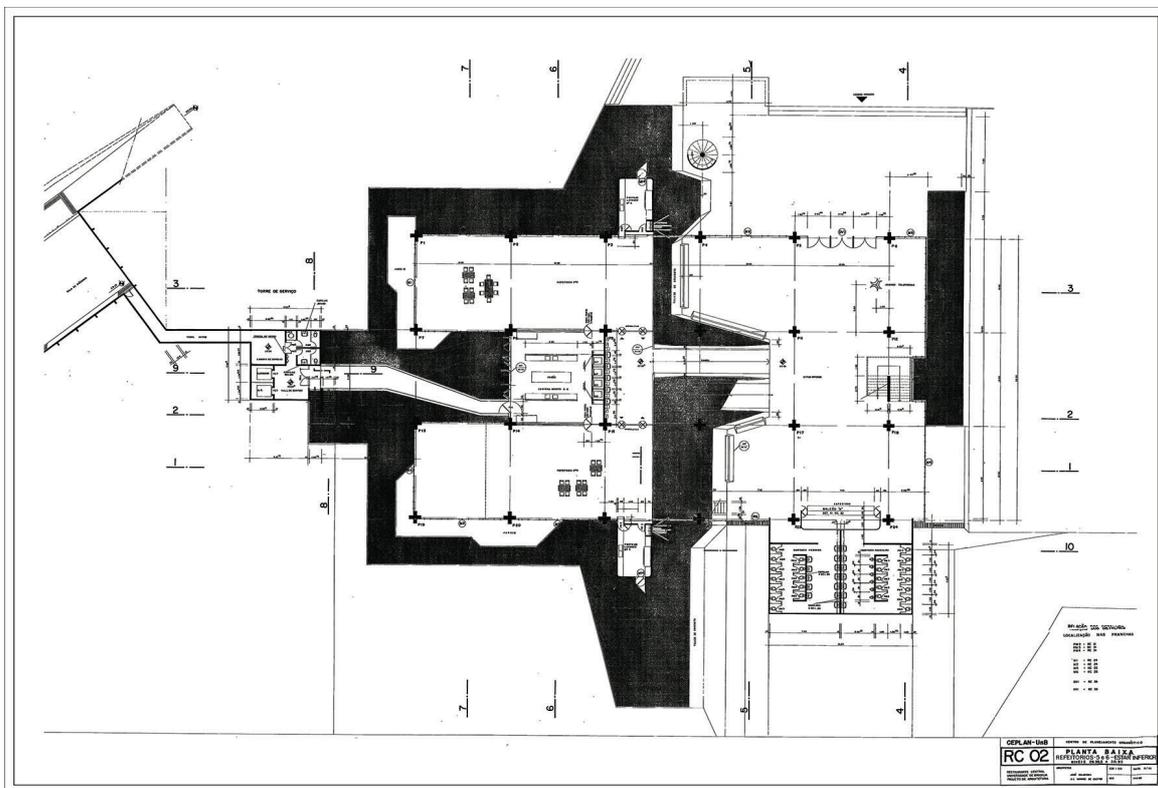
Restaurante Universitário. Planta Baixa nível Térreo Inferior. Fonte: Centro de Planejamento Oscar Niemeyer – CEPLAN-UnB
